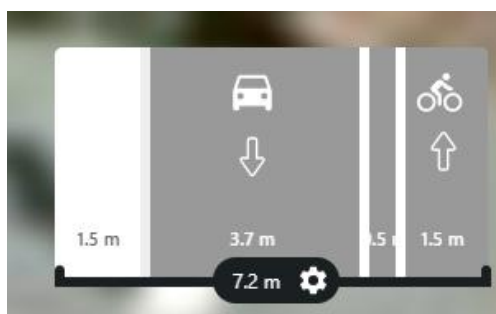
Pistes de solutions sur la rue Saint-Pierre - Option 1 - Profil en travers
